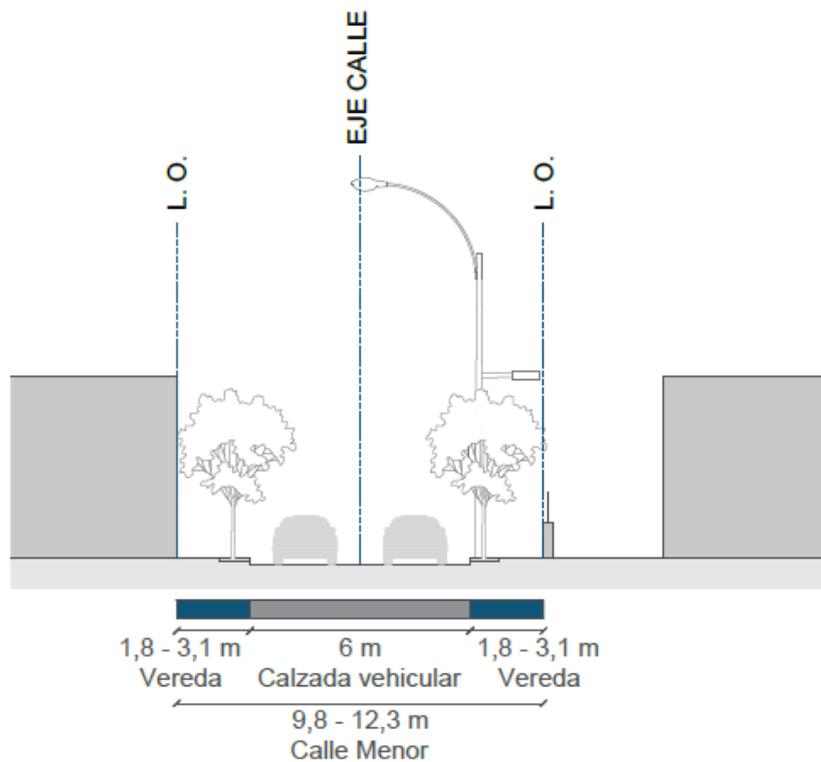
Perfil tipo. Situación existente en Calles Menores.
